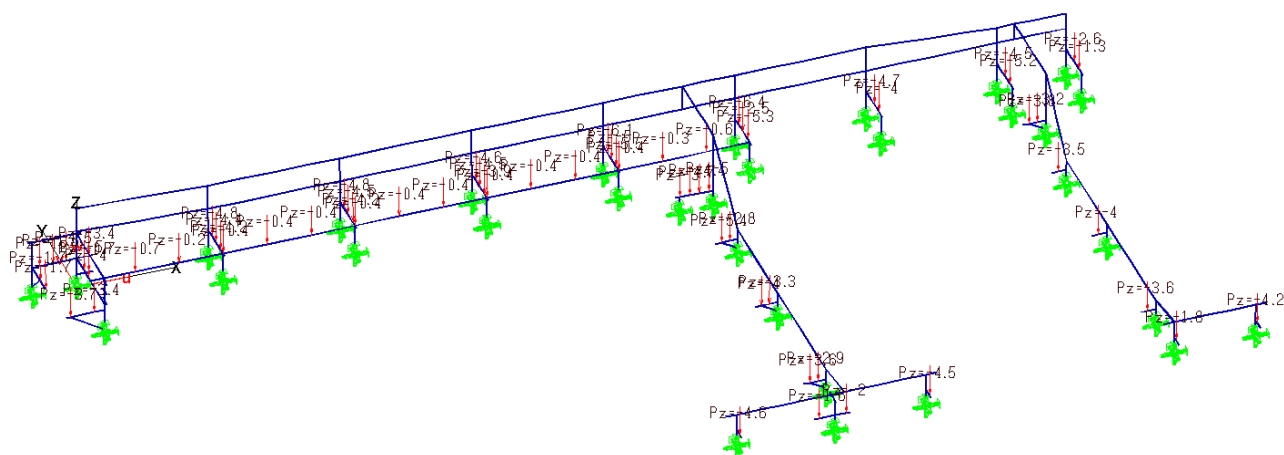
Вертикальная нагрузка от трубопроводов
